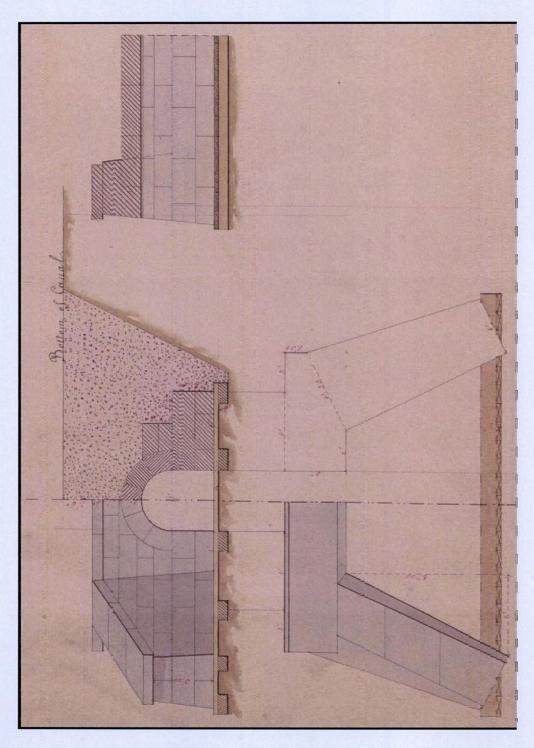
Décail du plan intitulé « Culvent az River St. Pierre » montrant l'aqueduc de 3 pieds Bibliothèque et Archives Canada, no 167/00/10-190, Fonds RG84M-8103/66, pièce no 06.
